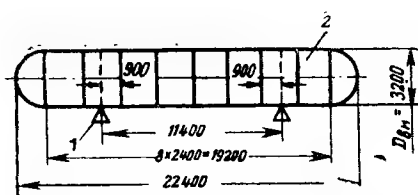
Схема горизонтального резервуара с полушаровыми днищами емкостью 175 м³
